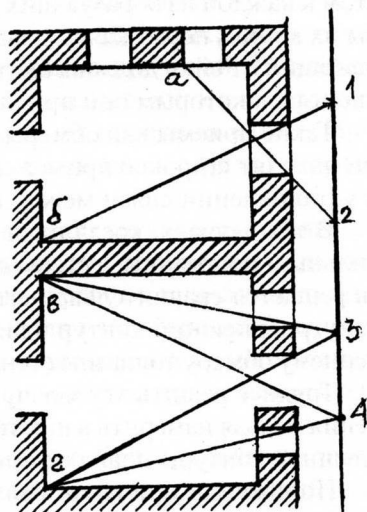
Привязка к причалке планов двух смежных, не связанных между собой помещений с проемами, выходящими на один фасад
